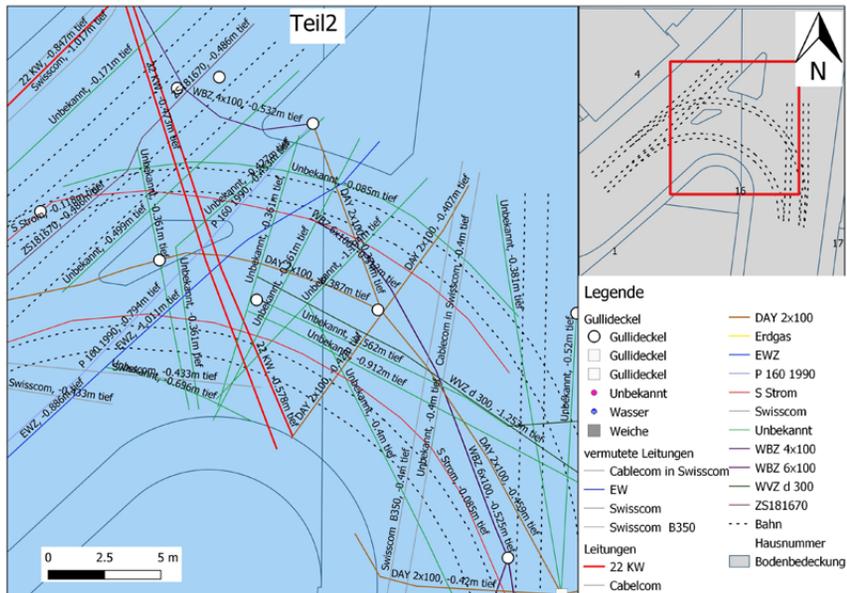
Vollständiger Leitungsplan im Stadtkern einer Großstadt (Detektionstiefe 2,00 bis 2,20 m) [Grafik: Wilhelm Dresselhaus]
